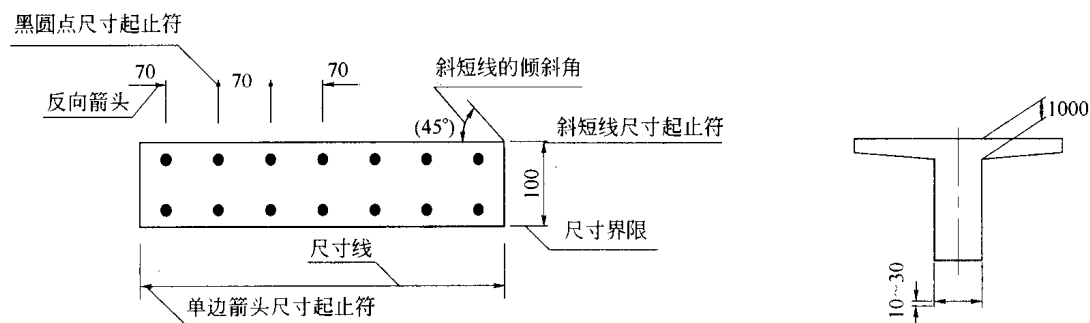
尺寸线、尺寸界线标注 (尺寸单位: mm)
